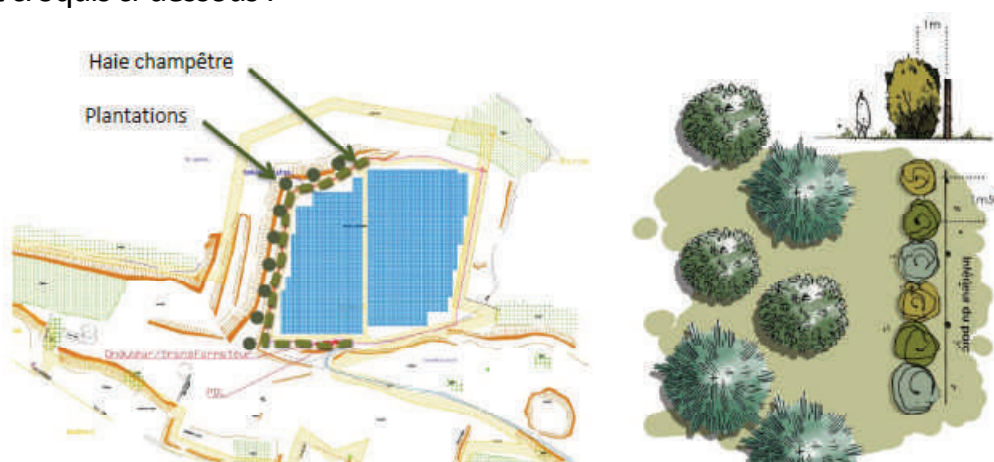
Plan de repérage et principe de plantation de la haie champêtre
